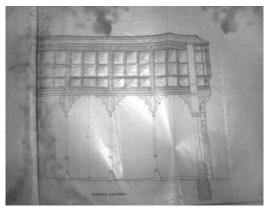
Galería de la casa de Tomasa García (1893). Plano del alzado de la galería, apoyada sobre pilares de fundición, del proyecto original redactado por Segundo Viloria. (Archivo Histórico Provincial de Zamora)
